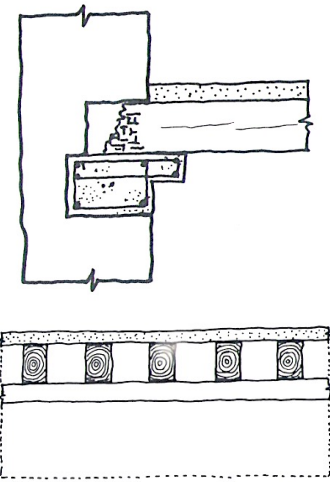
Apoio das extremidades das vigas. Solução com betão armado. Arriaga [1]
